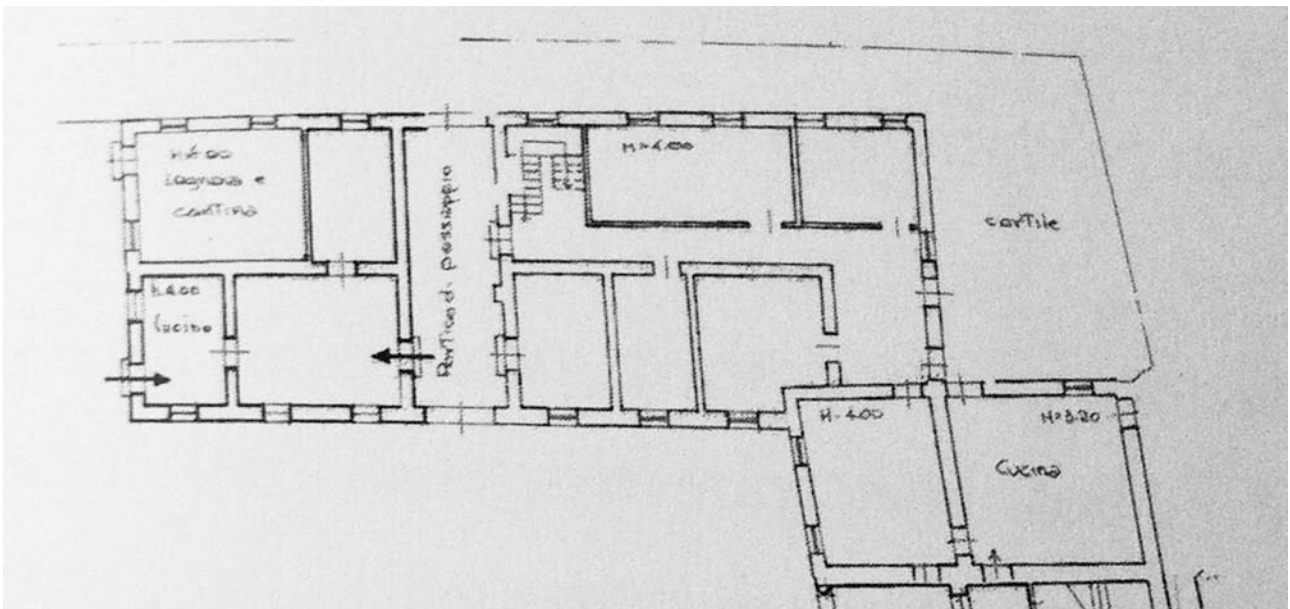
Pianta piano terra del nuovo nucleo di villa Rotàri, estratto catastale del 1984.⁵⁷
